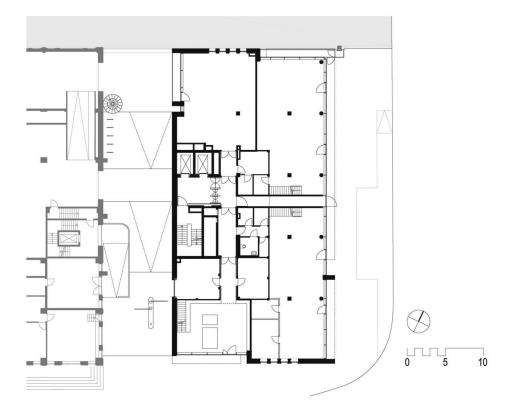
Planta baixa do pavimento tipo da Nova ampliação da sede da Gebr
